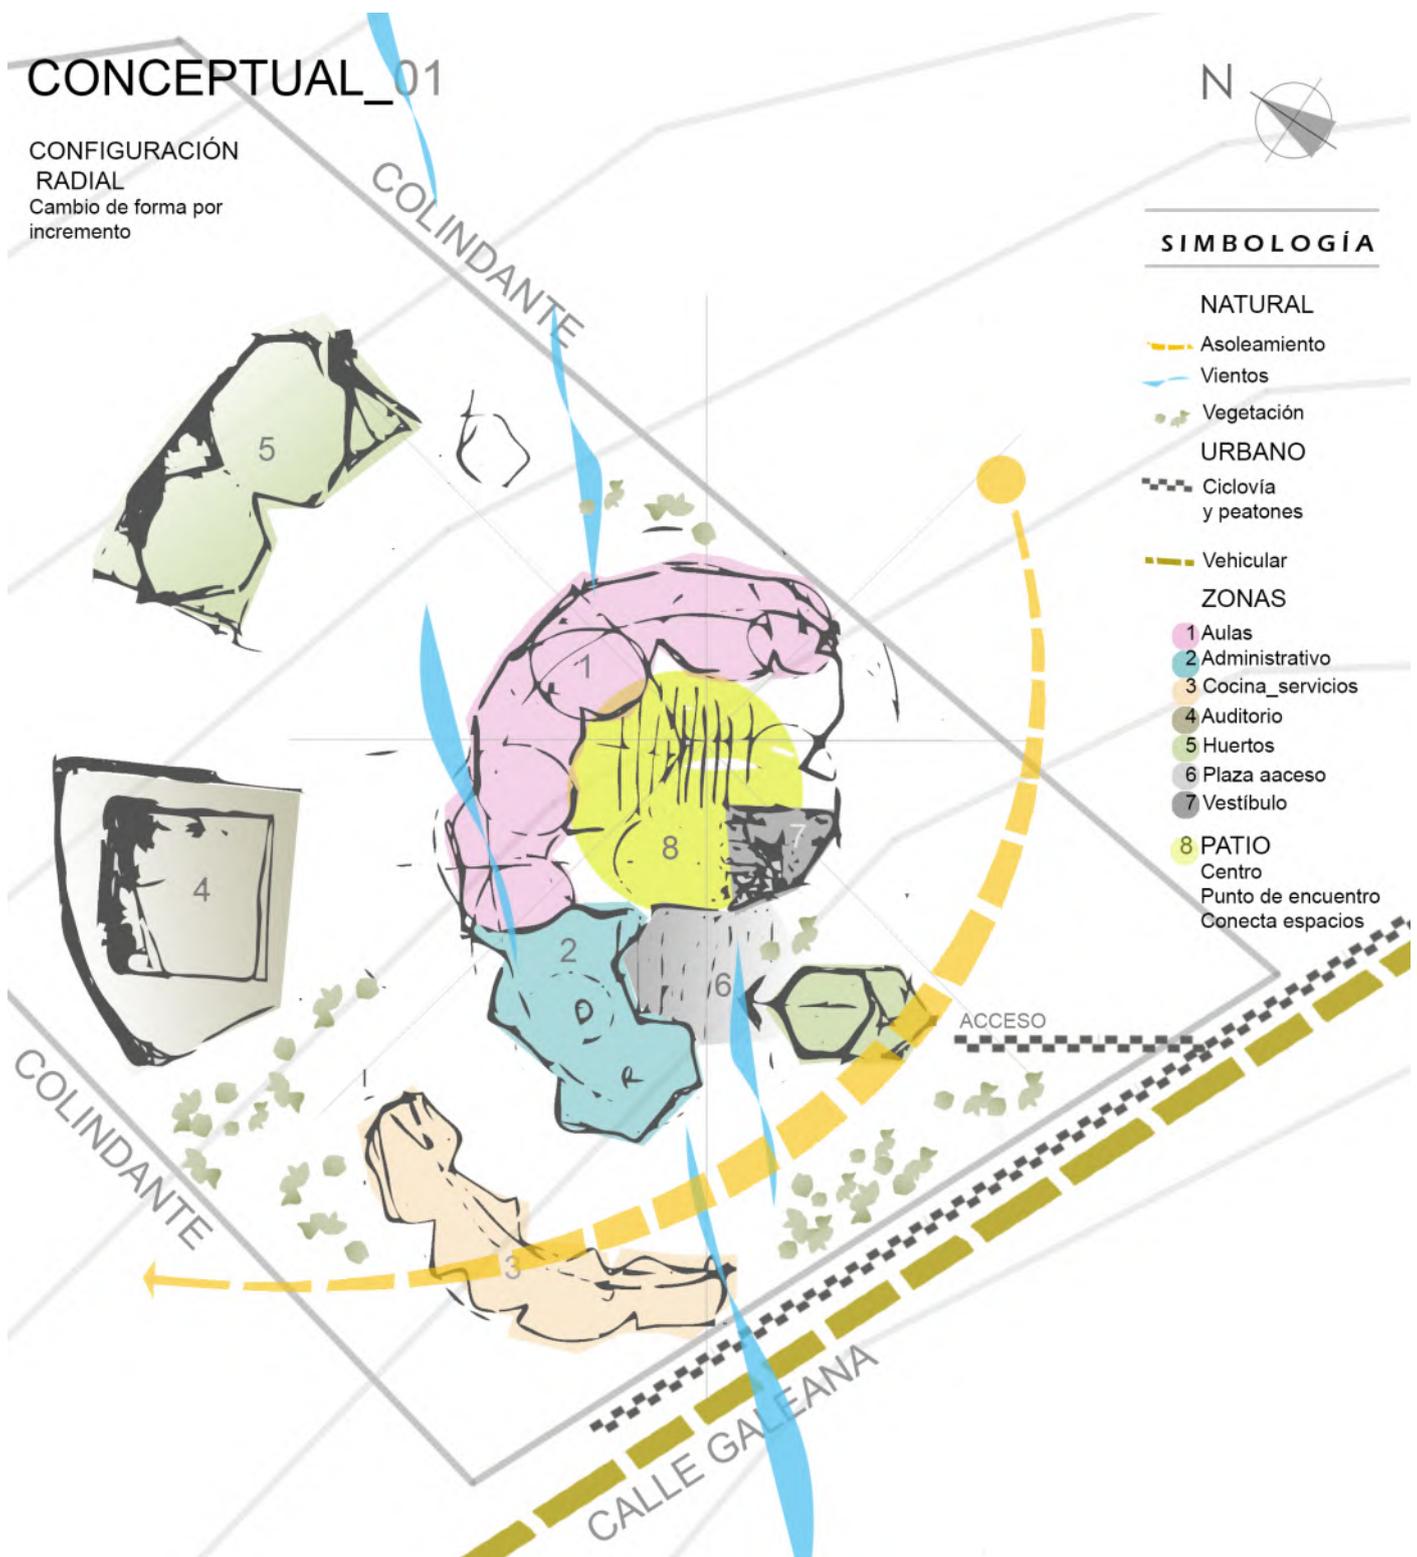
Diagrama de concepto en planta 01. Fuente: Autor.
